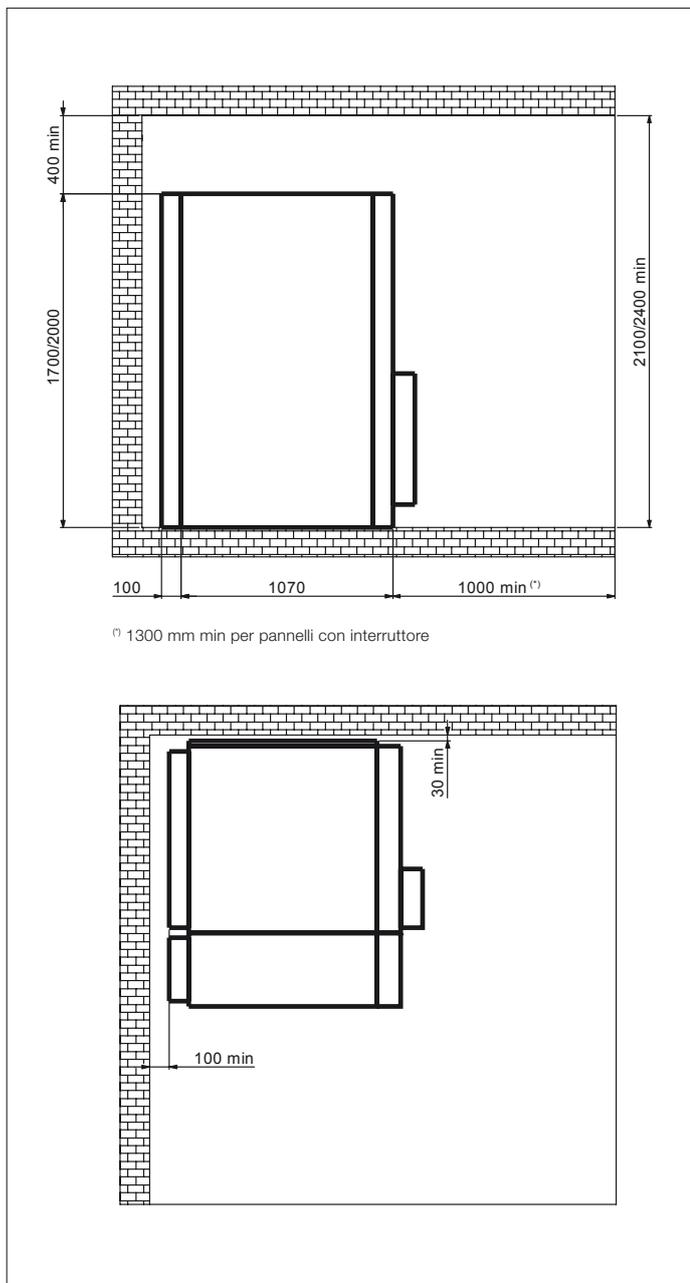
Distanze minime rispetto alle pareti del locale di installazione, soluzione IAC A-FLR 16 kA 1s con filtri montati su ogni singola unità
